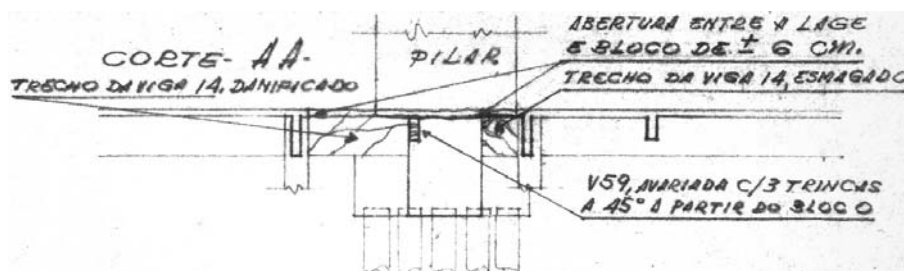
7 – Corte A-A do apoio central (Fonte: Pasta da Obra n° 1438, CRO-11, Brasília – 1974)
